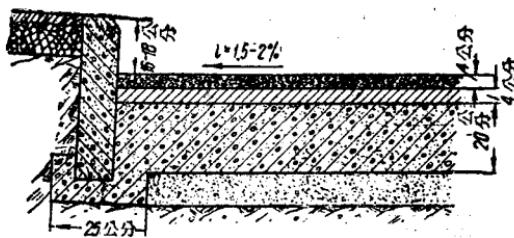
鋪在水泥混凝土基底上面的双層地壓青混凝土
